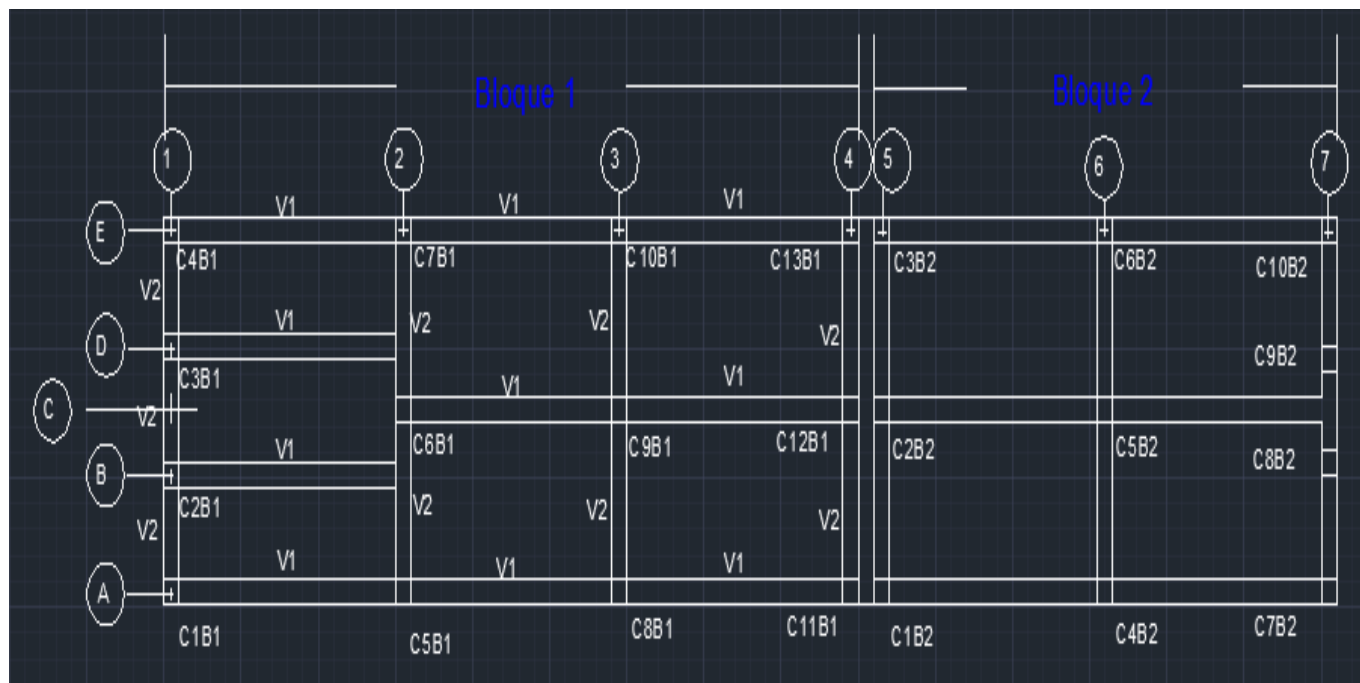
Distribución de vigas y columnas de la primera planta de los bloques 1 y 2
